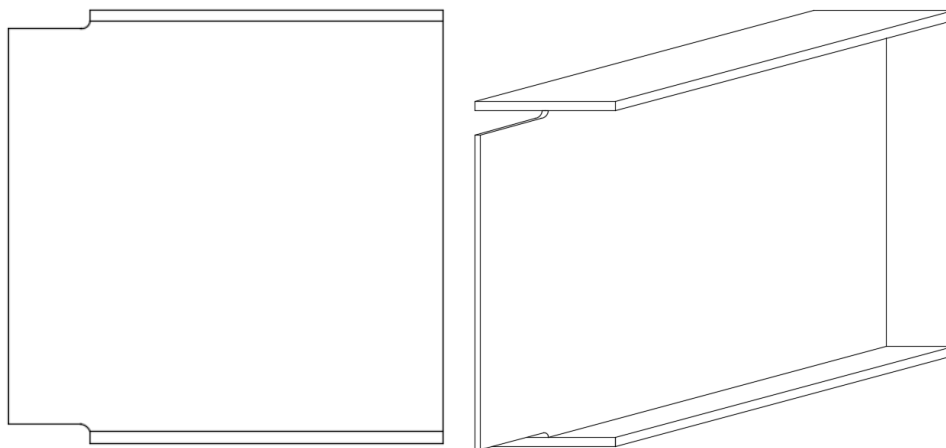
Detalles de la caladura a realizarle a los perfiles de las vigas transversales.
